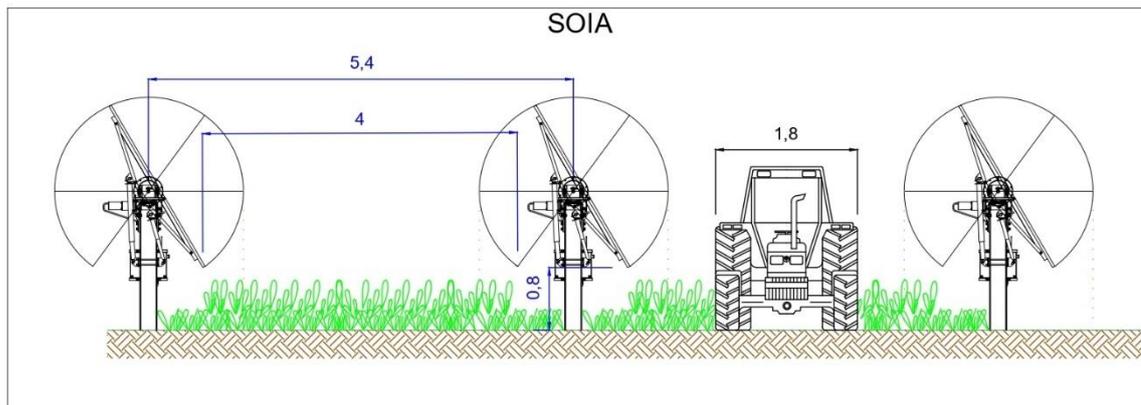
Rappresentazione del prospetto frontale delle colture di frumento, orzo, soia
